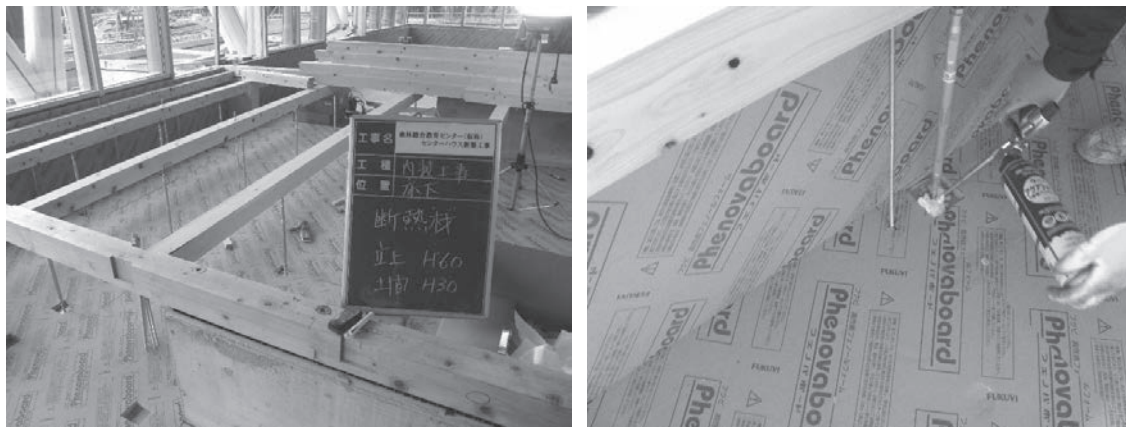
床下断熱材の施工（べた基礎の底盤上に断熱材を施工する場合）
